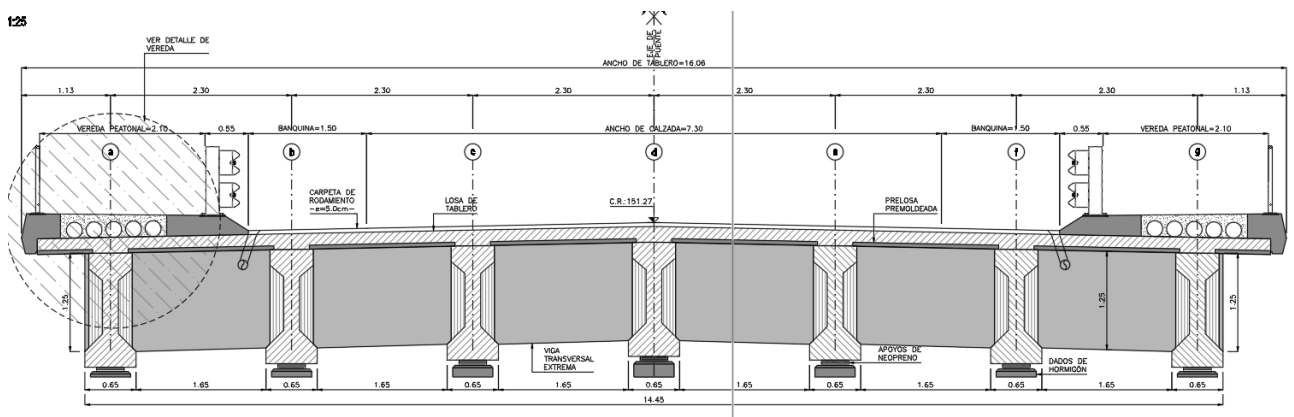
Perfil Transversal del puente – Posterior a las observaciones
